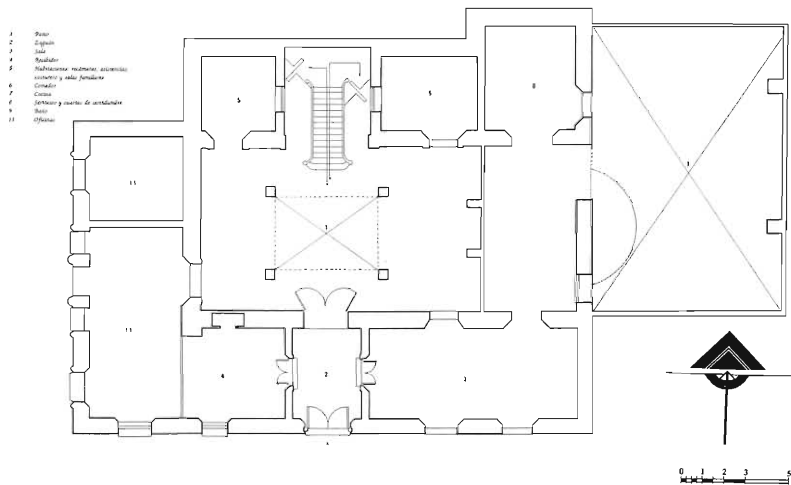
GUERRERO ESQ. ARMENTA Y LÓPEZ. PLANTA BAJA.
